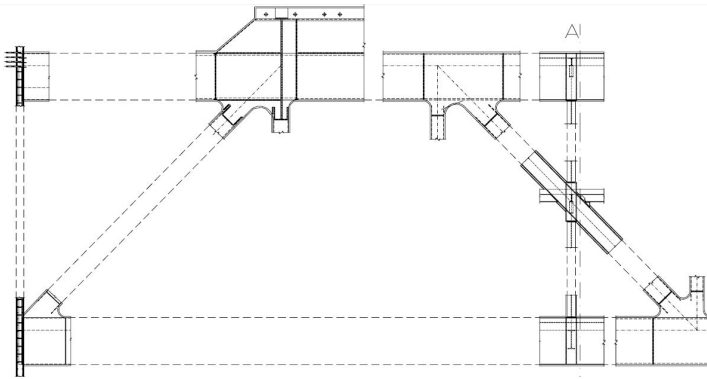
Celosía del 'Portaaviones'. Alzado constructivo.
